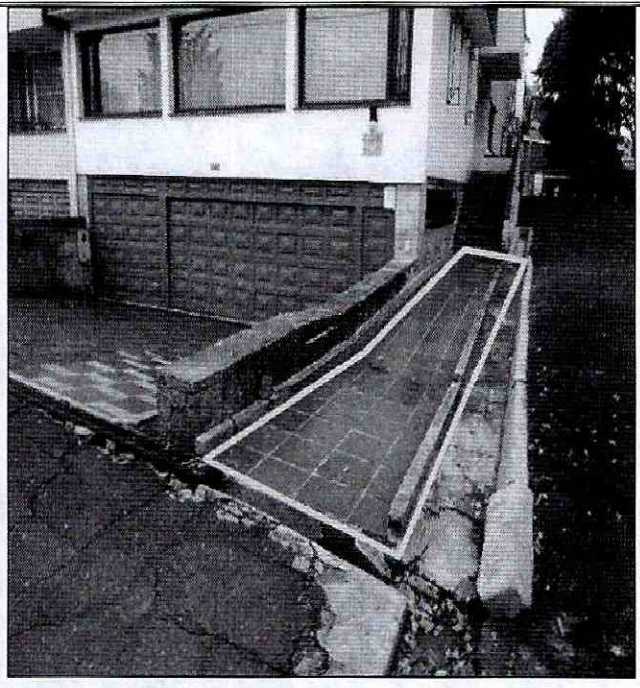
Grietas y fisuras observadas en muro de cerramiento del costado occidental del predio de la Calle 103 B No. 47 A - 03, en el Barrio Catastral Estoril de la Localidad de Suba.
